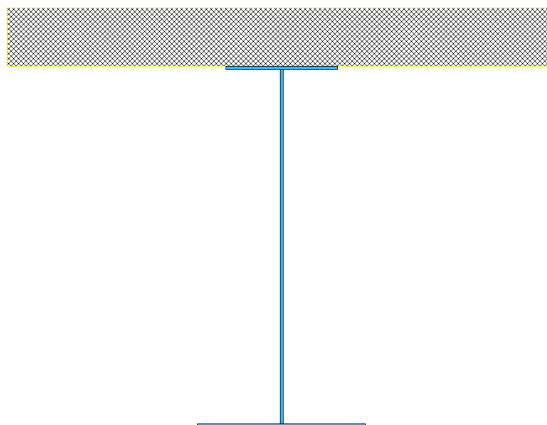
Geometria generica della sezione mista acciaio-calcestruzzo
